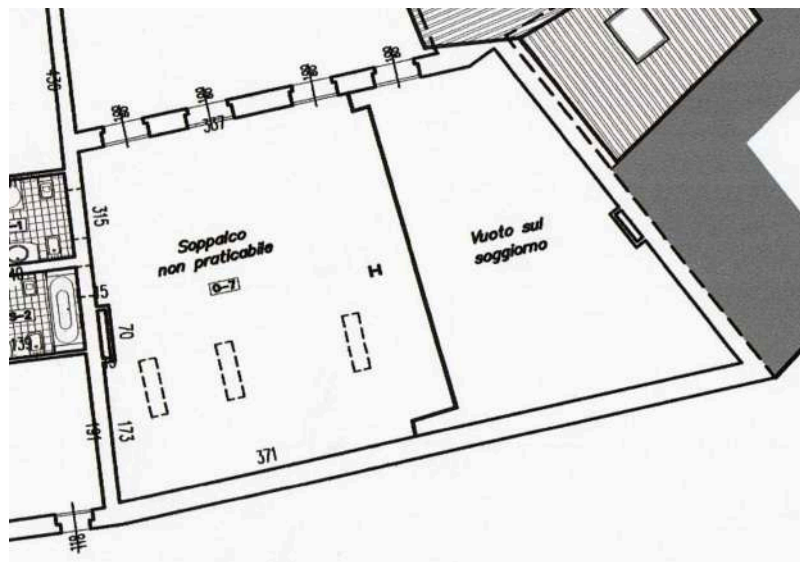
Planimetria immobili - Estratto progetto approvato (non in scala).
